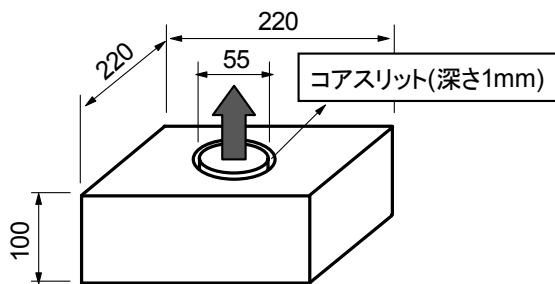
プルオフ強度測定方法 (単位 : mm)
